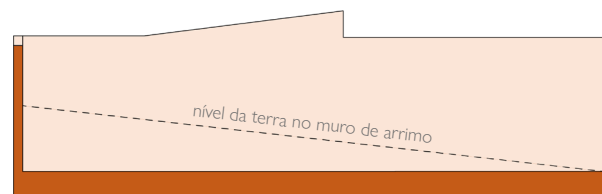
Implantação as built. Fonte: levantamento no local.
